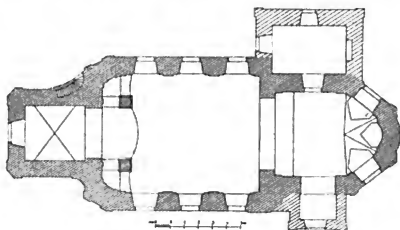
Zvíkovec. Grundriss der Kirche.
